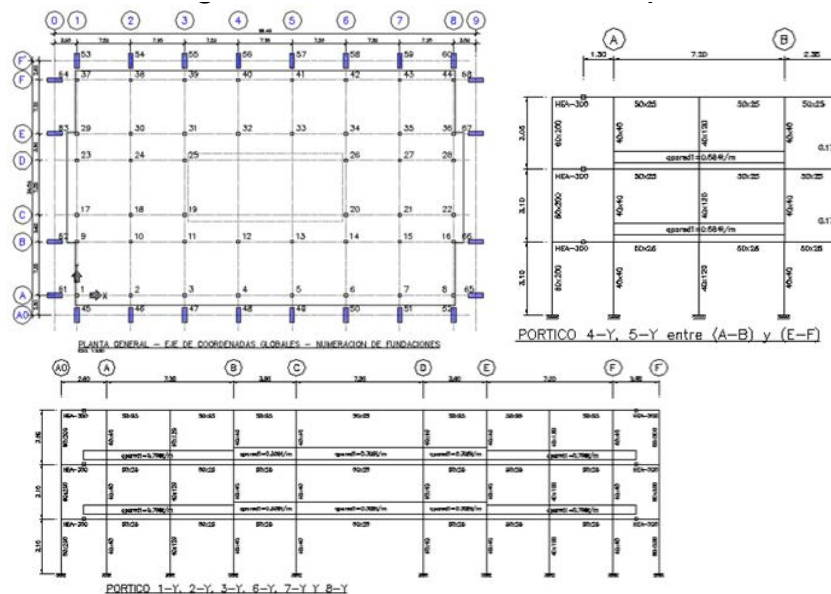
Incorporación de estructura perimetral externa.
